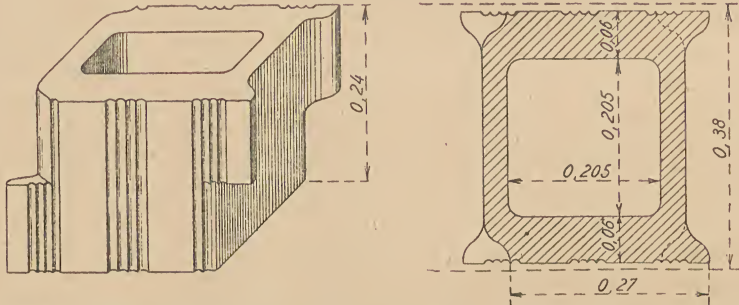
et 42. — Élévation et plan d'un wagon à joints coupés pour mur de 0.34 d'épaisseur (0.38 ravalé aux sous-faces).
